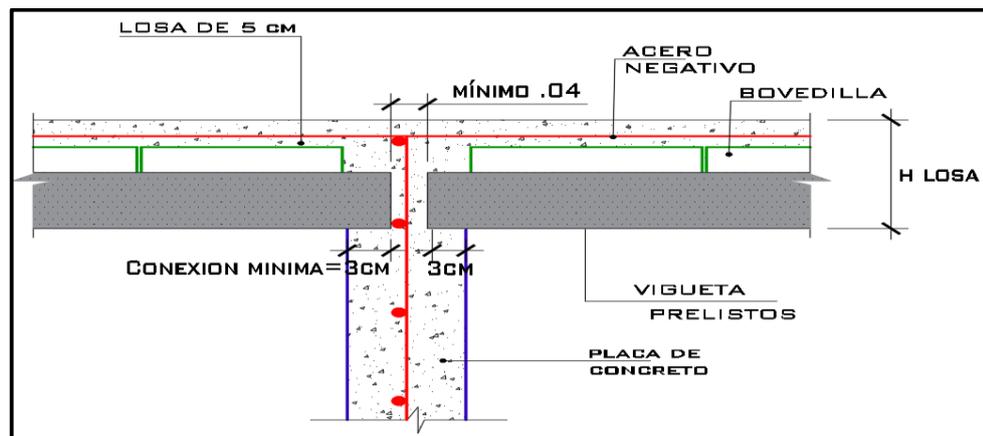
Detalle de ingreso de vigueta a muro MDL.
